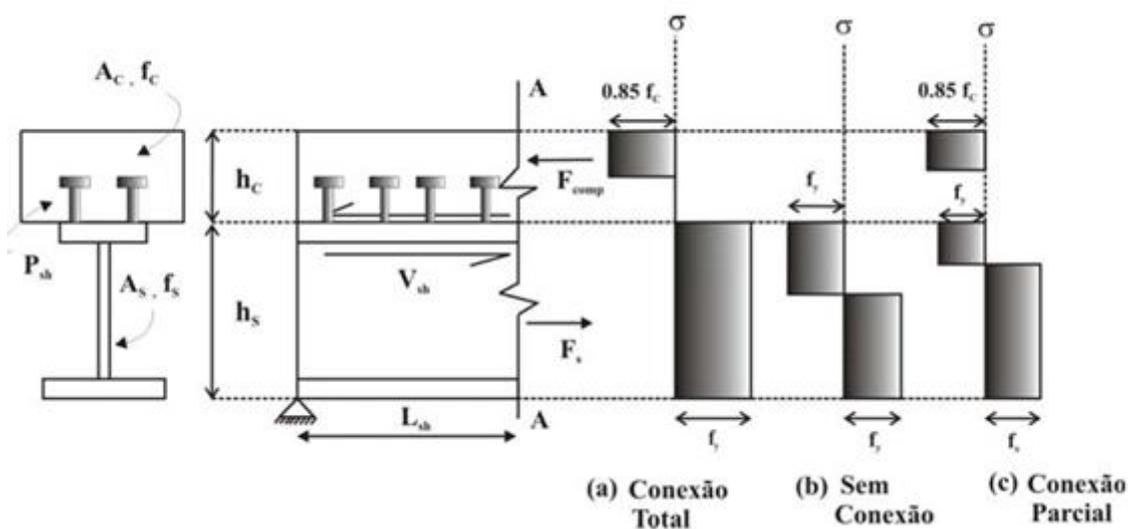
Equilíbrio longitudinal de forças na viga mista (Oehlers *et al*, 1997)
